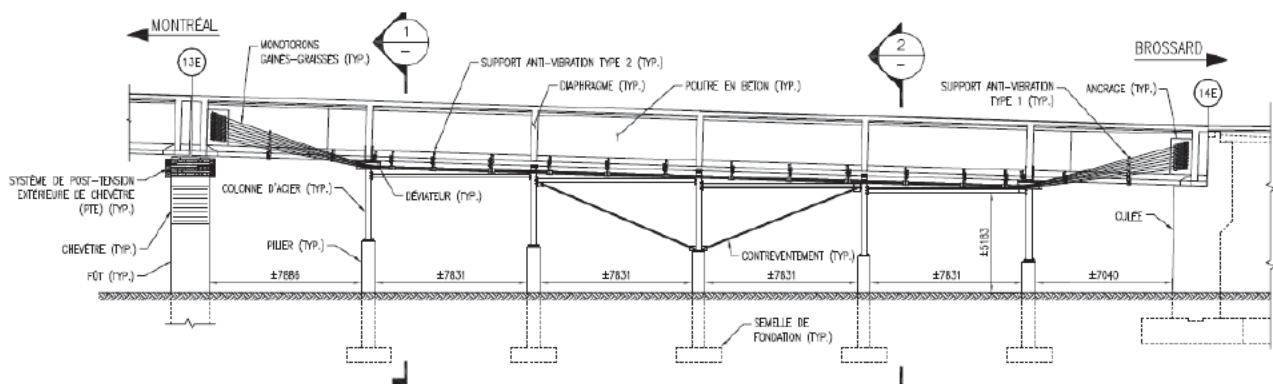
Poutres en béton – Système de renforcement de travée avec étaieiment et QP2 (source : plans nomenclature PJCCI)
